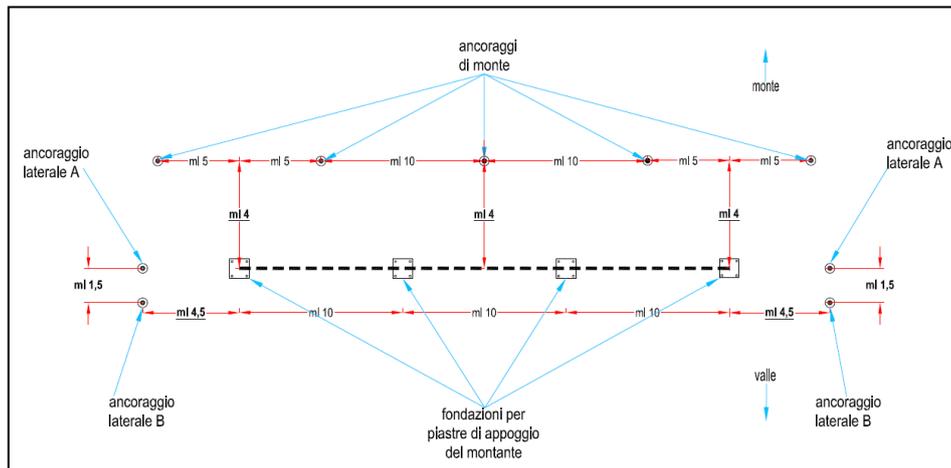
Schema planimetrico tipico della barriera paramassi
